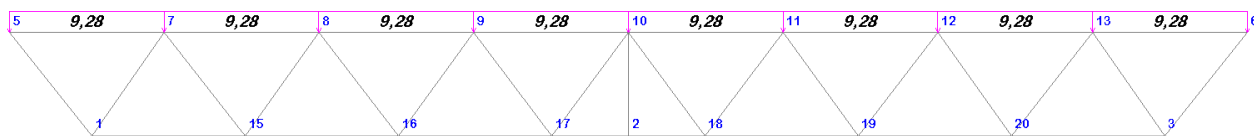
Воздействие распределенной снеговой нагрузки на верхний пояс стропильной фермы
